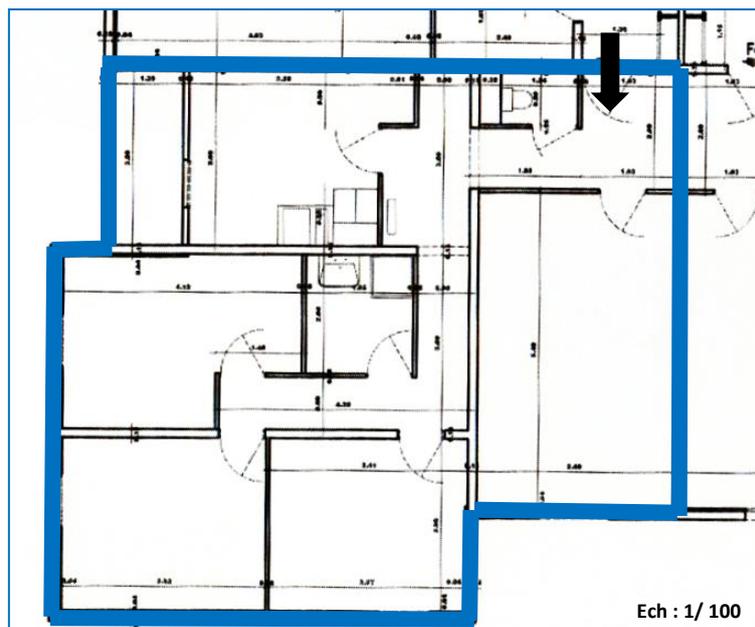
Disposition spatiale en plan du logement 2 en bloc 24. Source : Auteur, 2022
